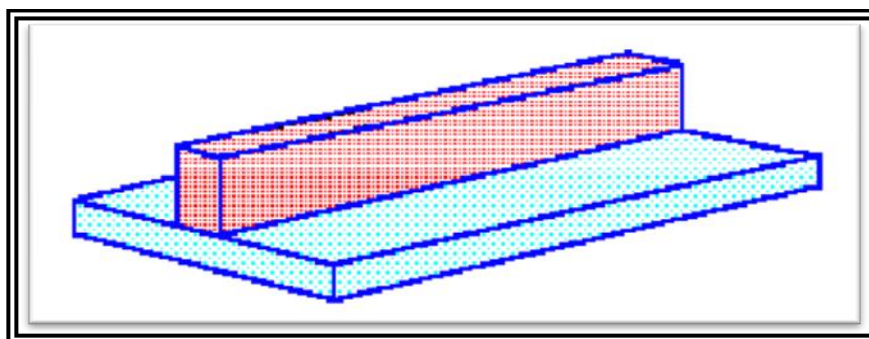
81 Zapata de muro o corrida¹⁰³.
